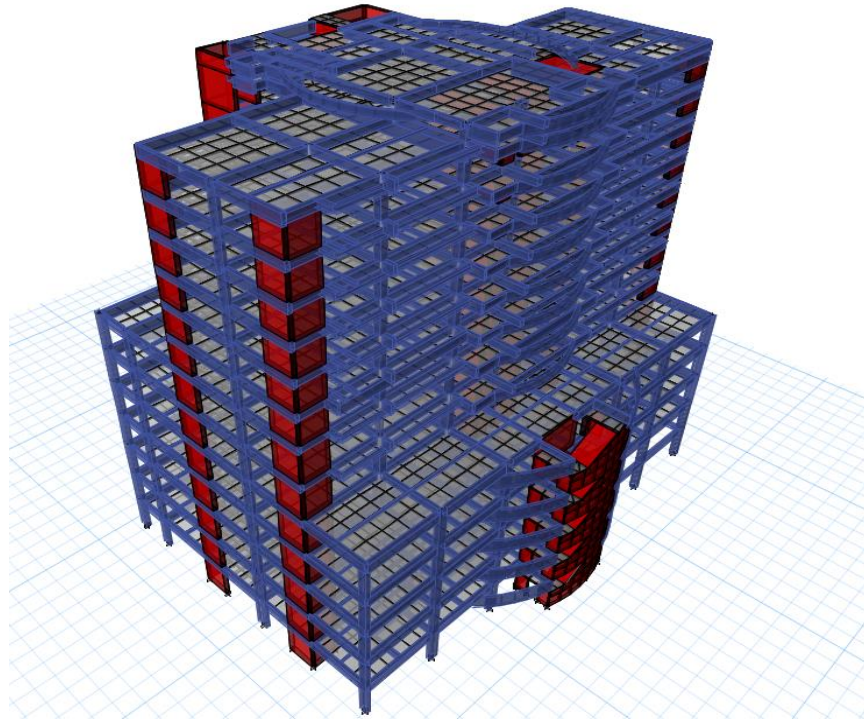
Vista 3d sin incorporación de dispositivos de protección sísmica.
